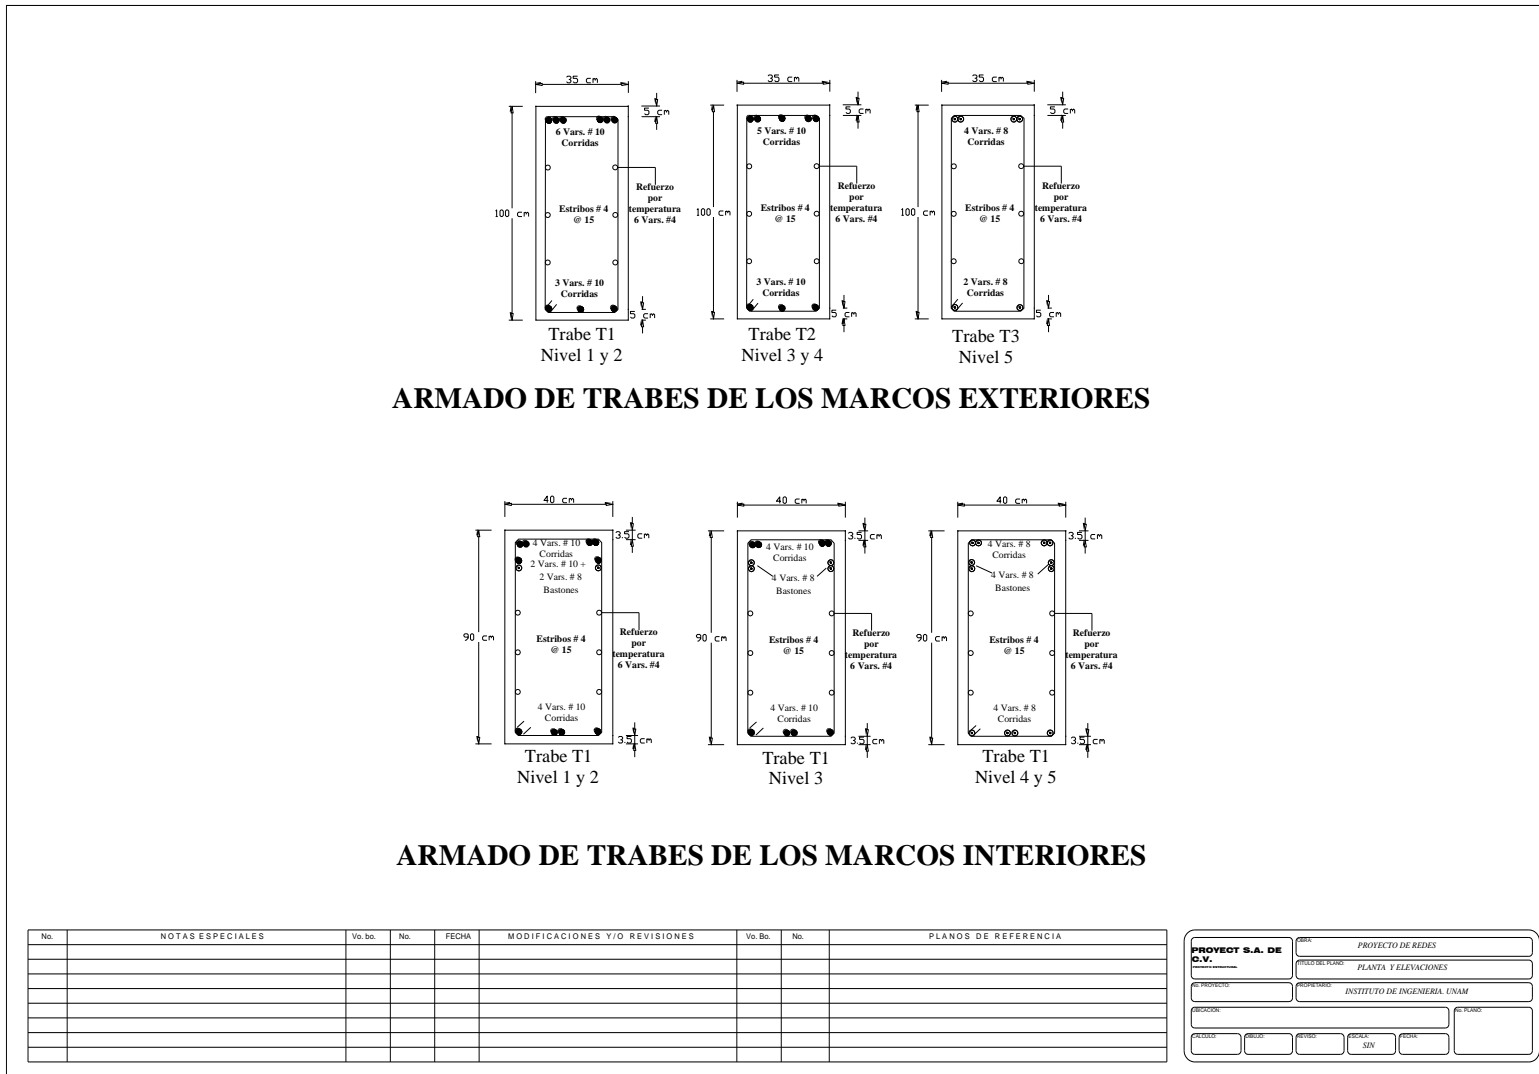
Detalles estructurales del edificio de 5 niveles diseñado con el RCDF-04
